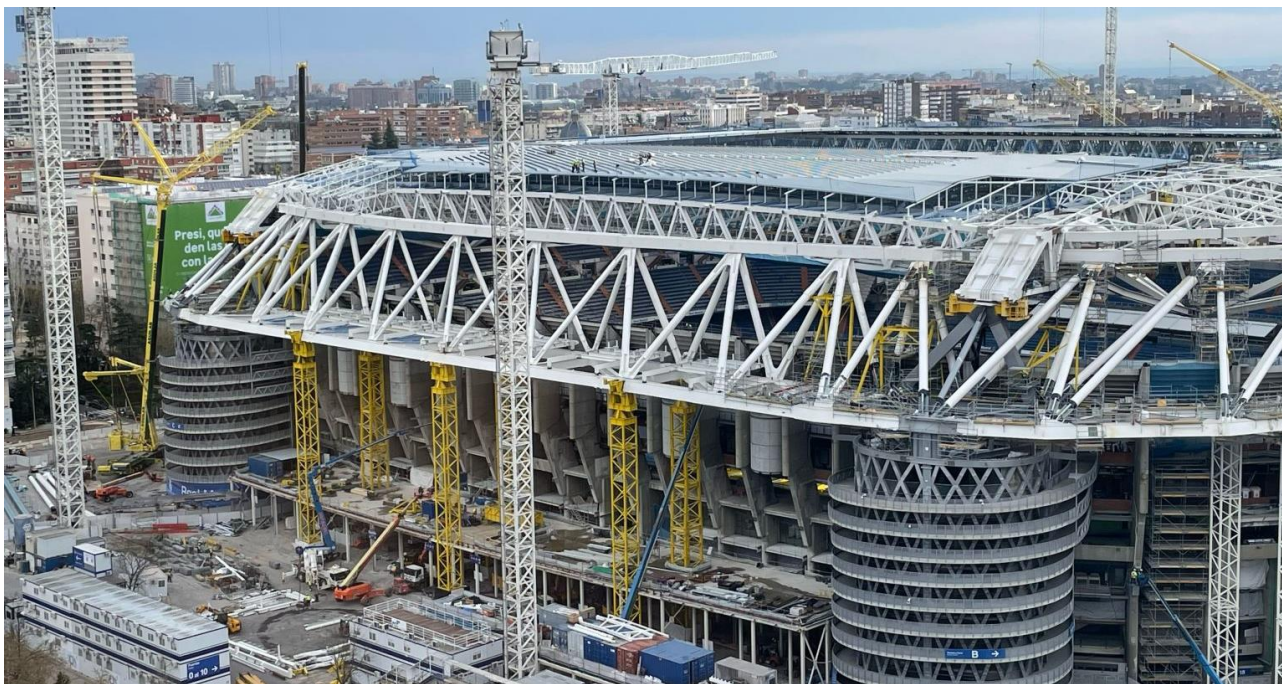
Estructura metálica de la corona completada previo desapeo de las torres [3]
